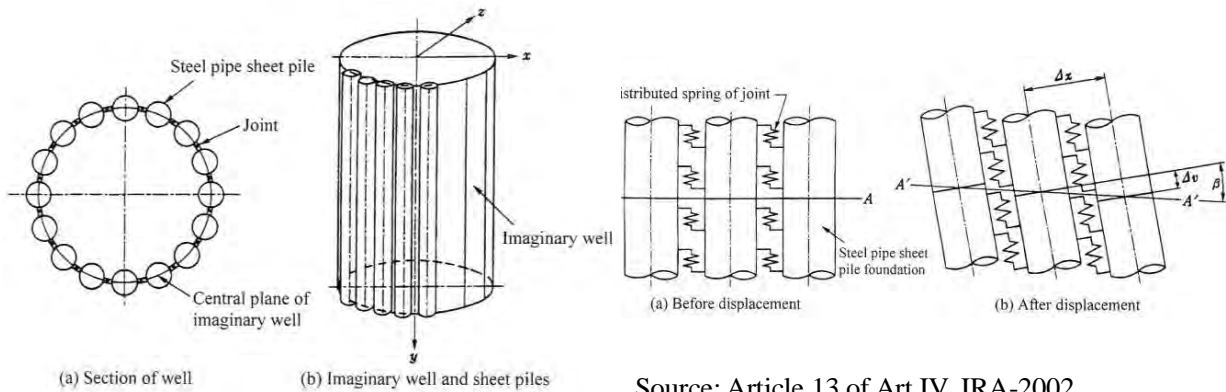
Mô hình tính toán Móng Cọc ván ống thép
